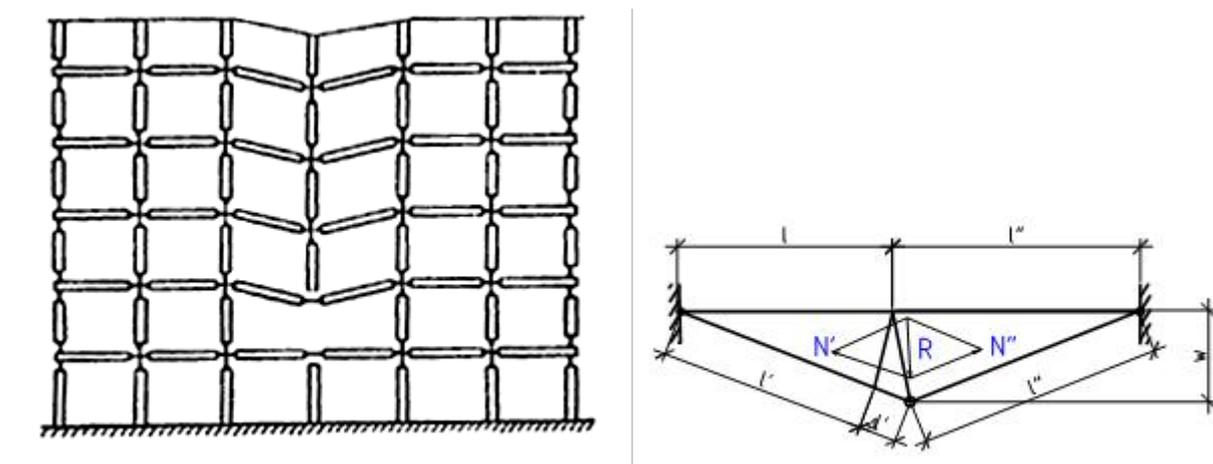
Работа плит перекрытий как элементов висячей системы
